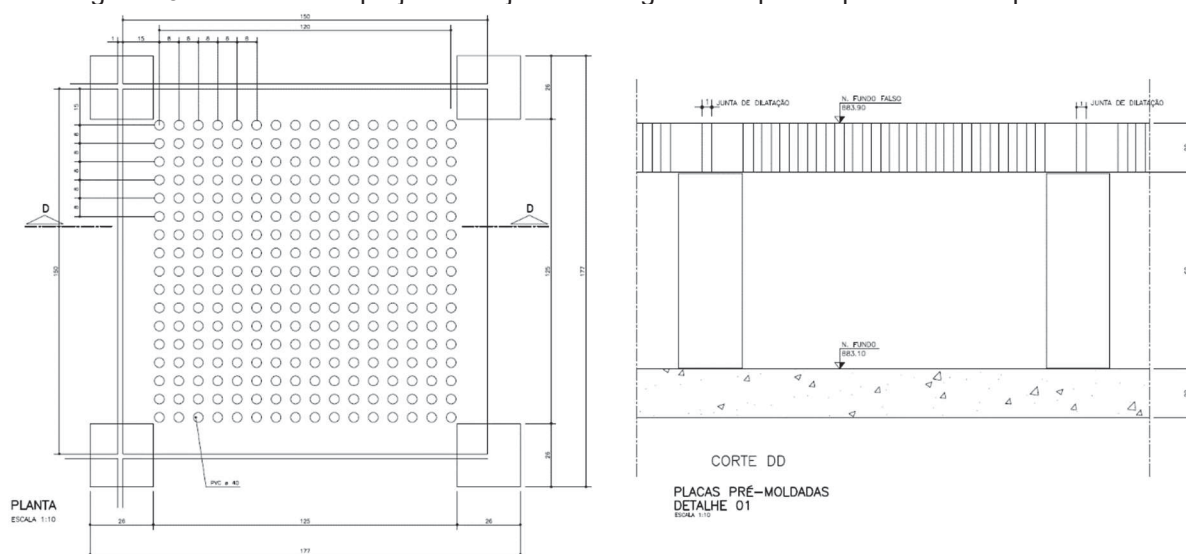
Meio suporte em pedra brita exige laje de drenagem com função estrutural
